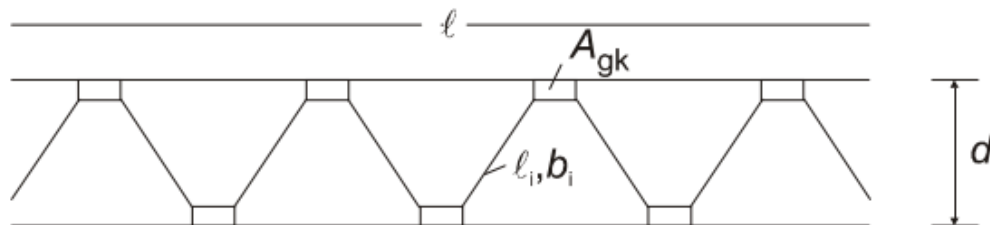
Estrutura treliçada (Fonte: EC1-1-4)
